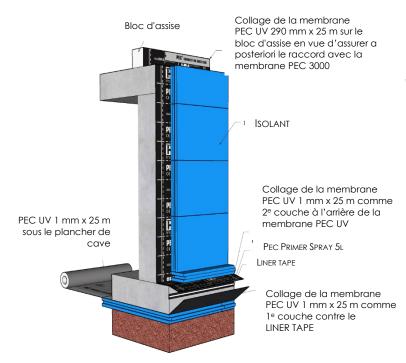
Application de la membrane PEC 3000® sur caves en béton coulé ou préfabriqué avec panneau isolant rigide
